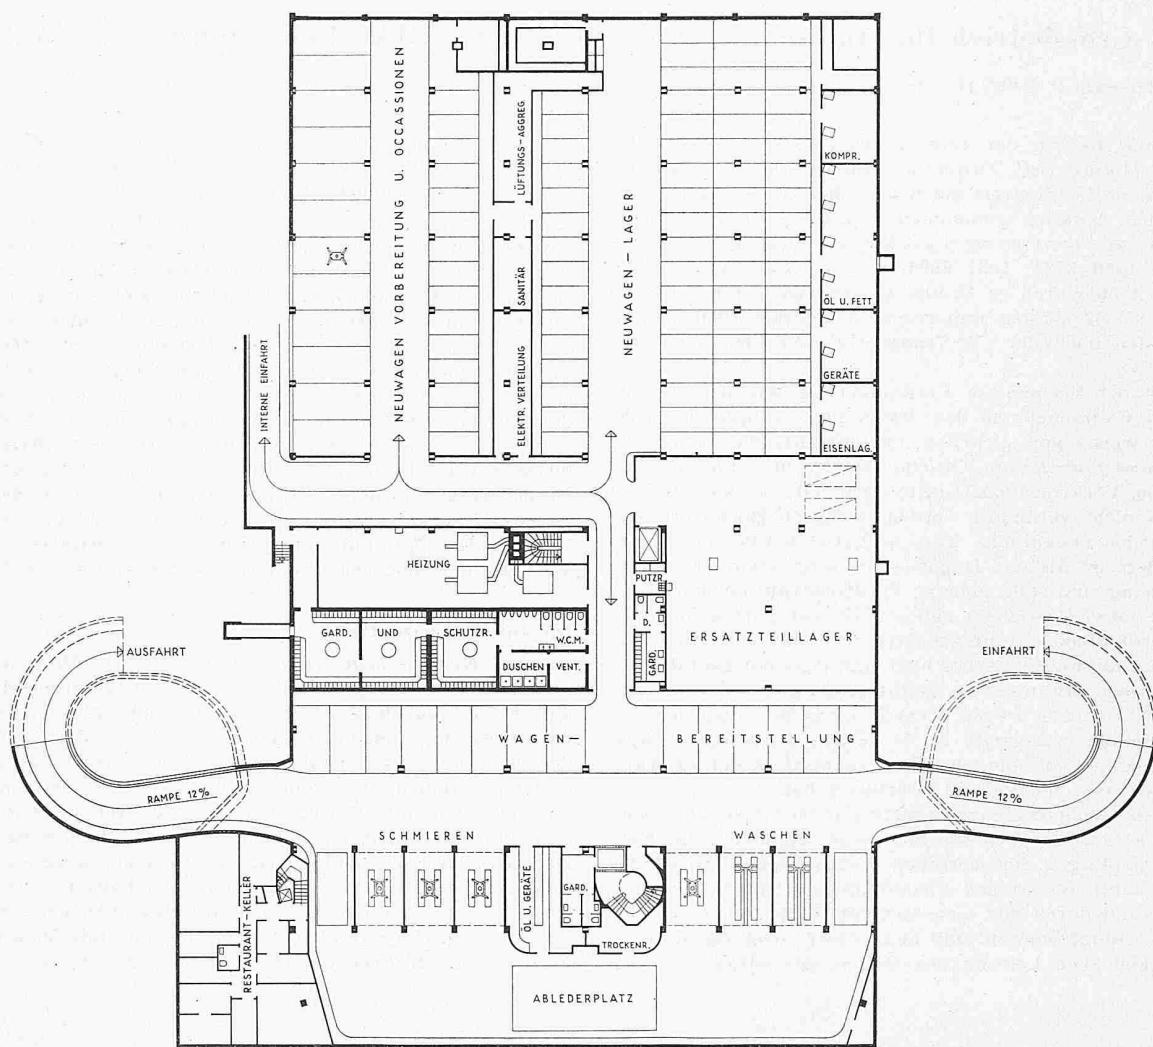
Grundriss des Kellergeschossses 1:600
